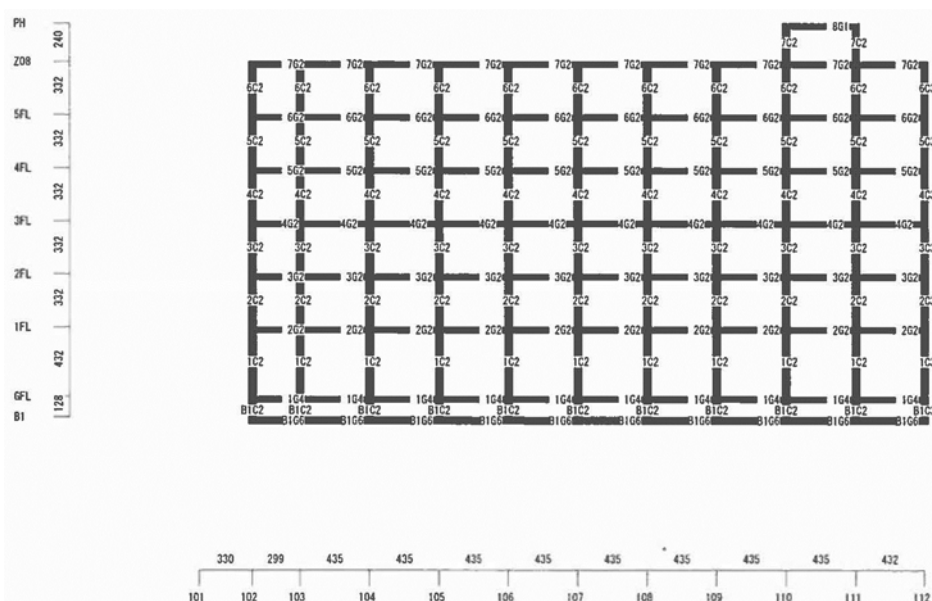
Un dibujo de muestra de una elevación de encuadre estructural
